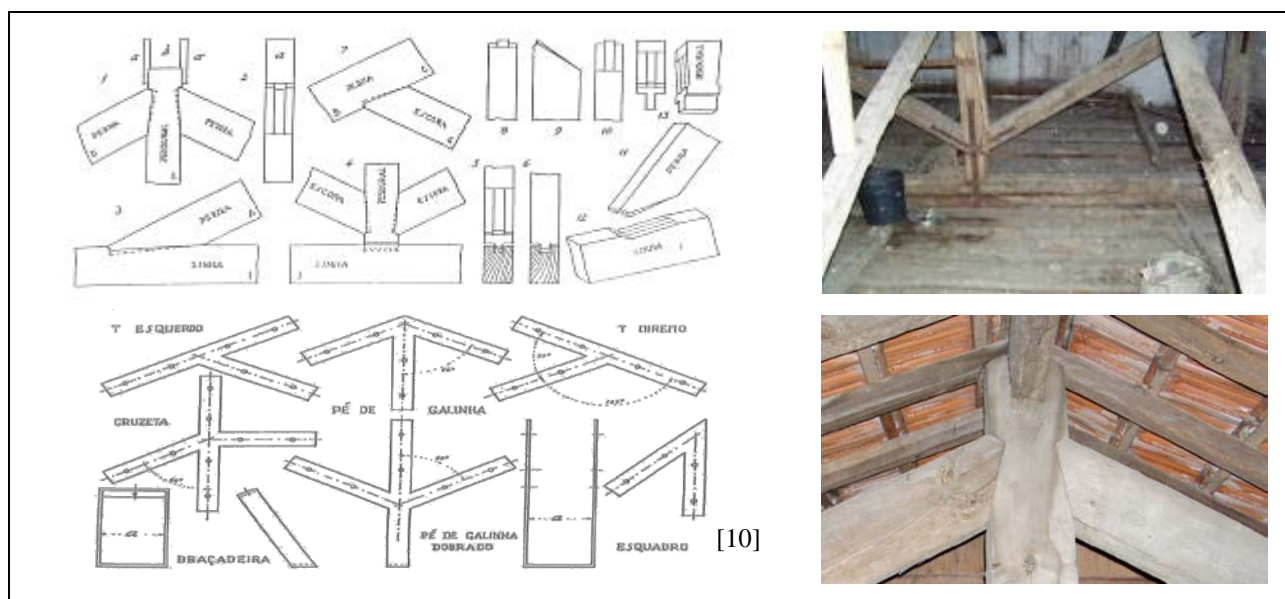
Ligações entre elementos da estrutura das asnas de cobertura (samblagens e ferragens)
